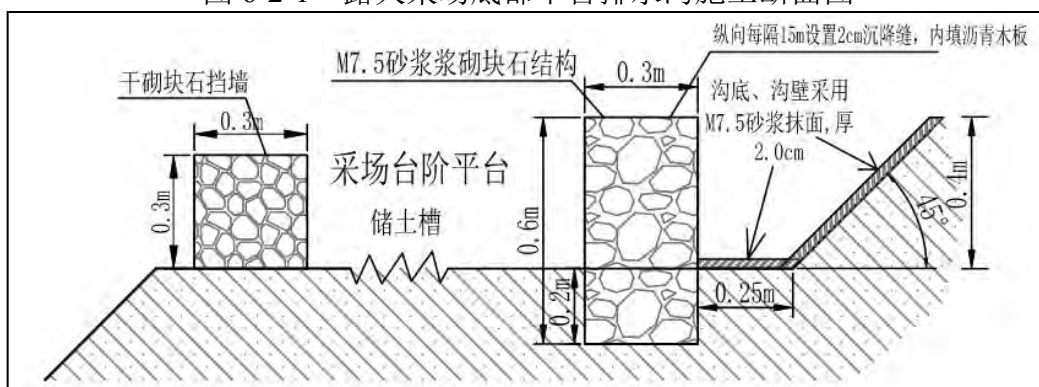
露天采场台阶平台内外侧排水沟、挡墙施工断面图
